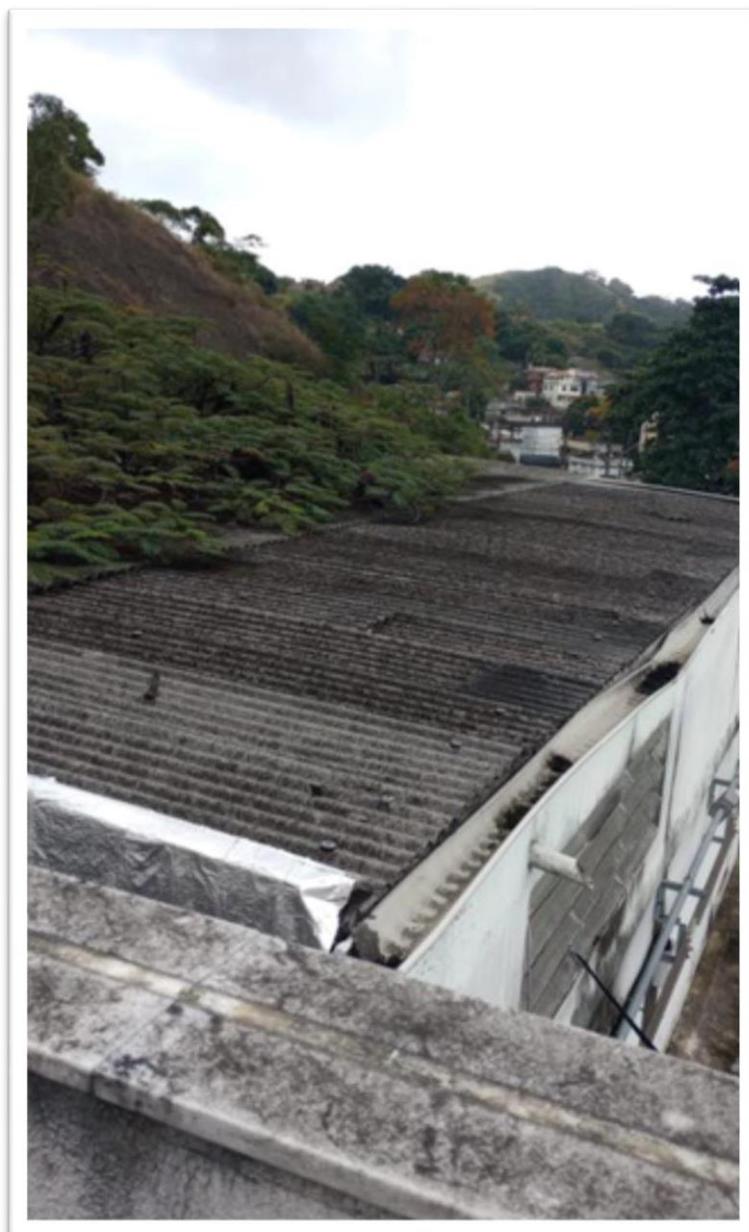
e 40 – O telhado da casa de máquinas do elevador precisa ser substituído, as telhas encontram-se degradadas causando constante infiltração na área da enfermaria do prédio antigo.
